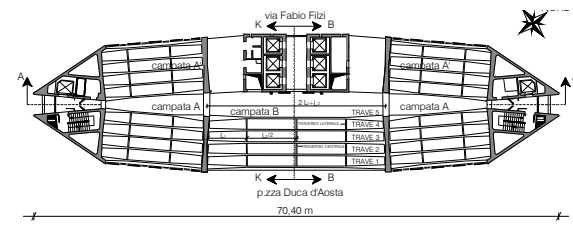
Pianta dell’impalcato tipo del palazzo Pirelli
